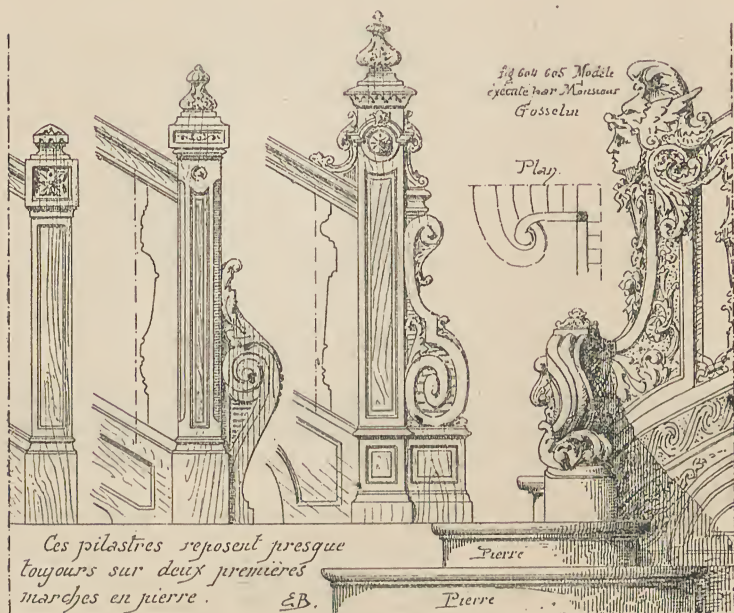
, 637, 638, 639, 640. — Types de pilastres de départ.
